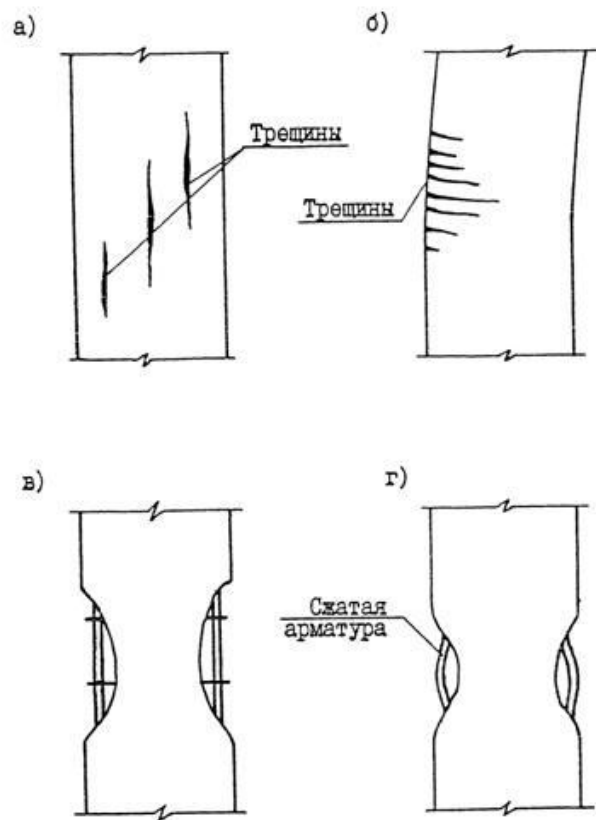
Дефекты и повреждения железобетонных колонн
